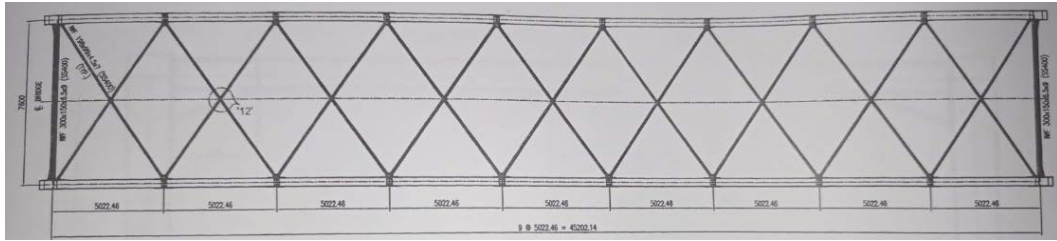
Denah Atas Jembatan Bentang 60 m
